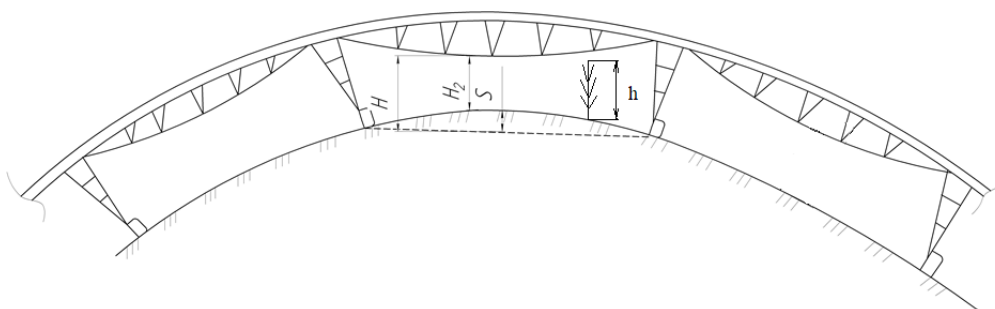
Конструктивно-высотные свойства машин ферменной конструкции водопроводящего пояса
